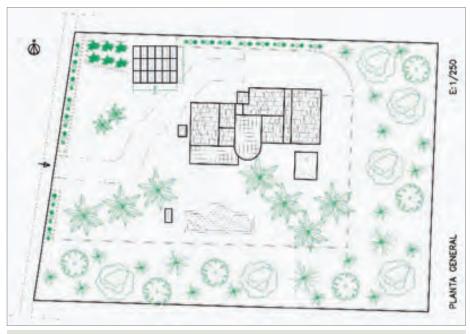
Vista en planta de la vivienda y de la instalación fotovoltaica a instalar
